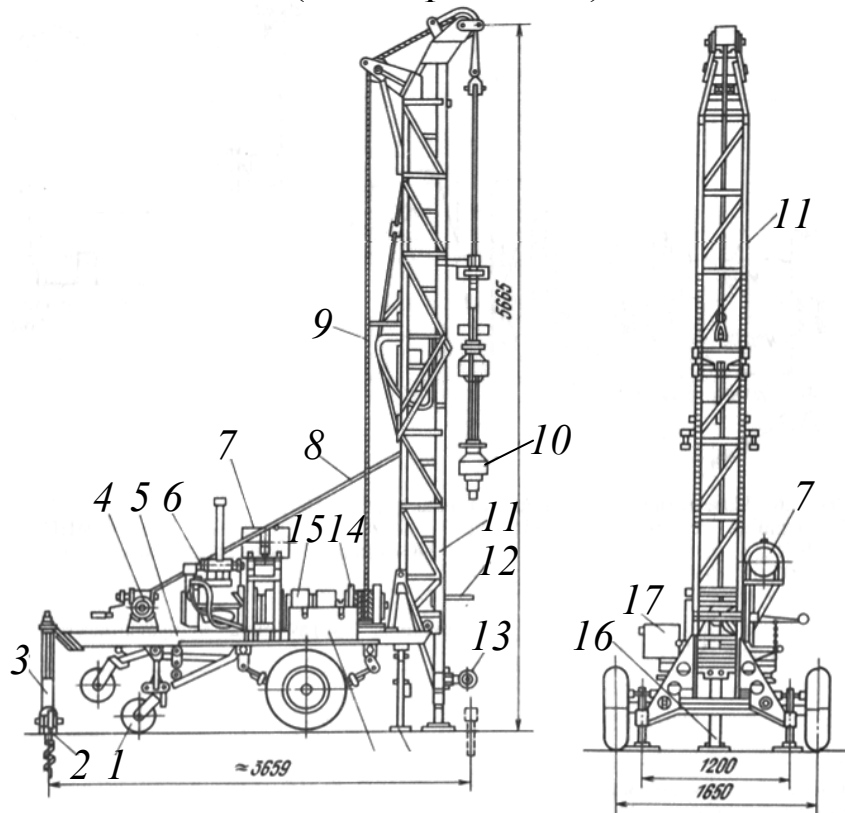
Установка буровая УБП-15М: 1 – каток; 2 – стопор шнековый; 3 – анкер; 4 – лебедка ручная; 5 – рама; 6 – двигатель; 7 – бензобак; 8 – вспомогательный канат; 9 – канат; 10 – молот; 11 – мачта; 12 – центратор; 13 – направляющий ролик; 14 – лебедка; 15 – редуктор; 16 – задняя опора; 17 – ящик для слесарного инструмента
